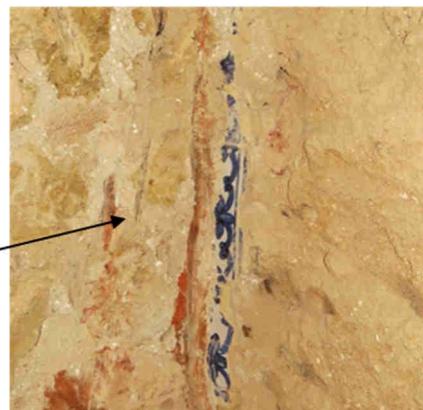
Vão entaipado na Parede 5 e pormenor de revestimento e azulejo de cantoneira.
